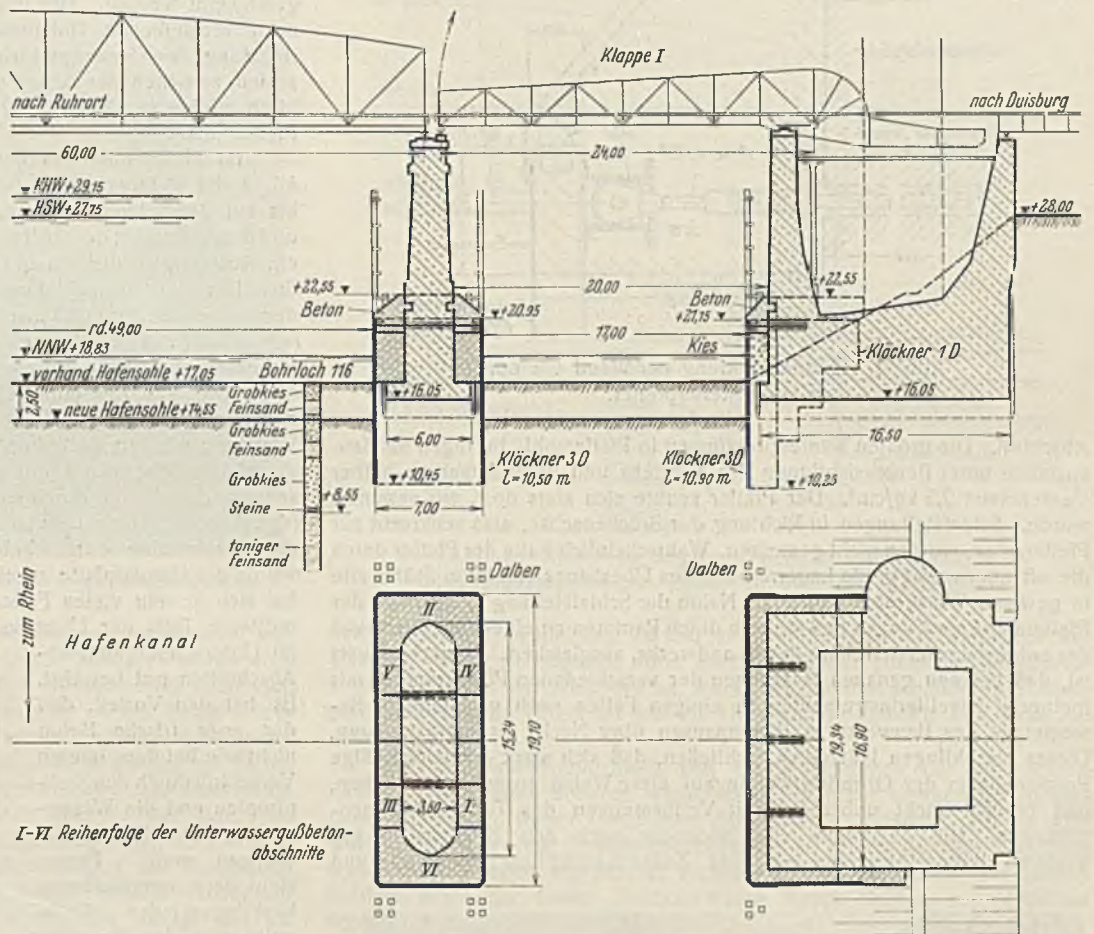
Sicherung der Grundwerke der Oberbürgermeister-Lehr-Brücke II über den Hafenskanal.
